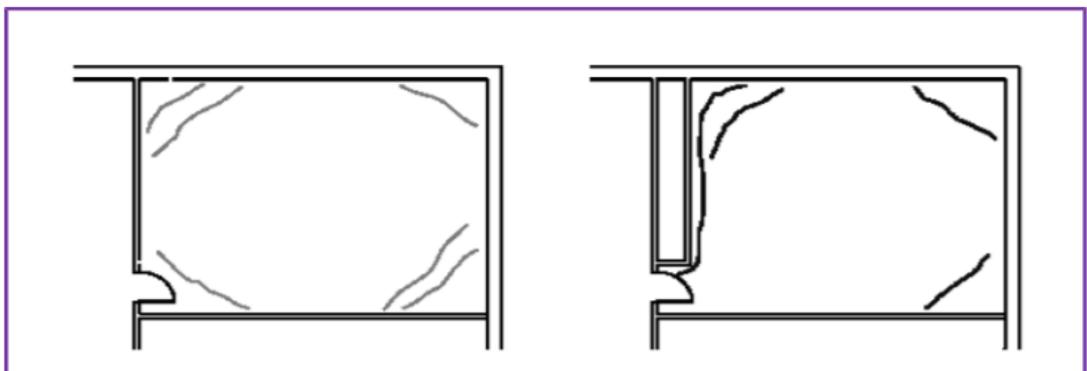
FISURAS POR RETRACCIÓN TECHOS O PISOS
